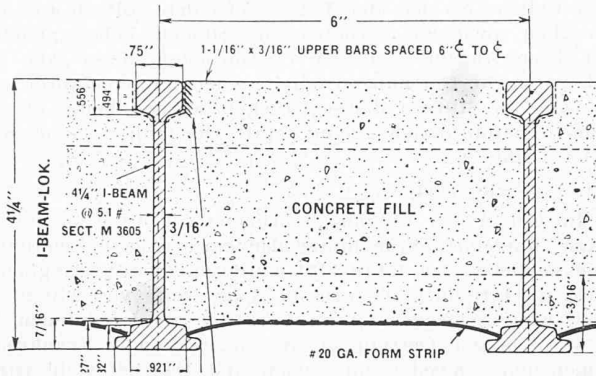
Fahrbahntafel aus eisernem Rost mit Betonfüllung. Masstab 1:3
